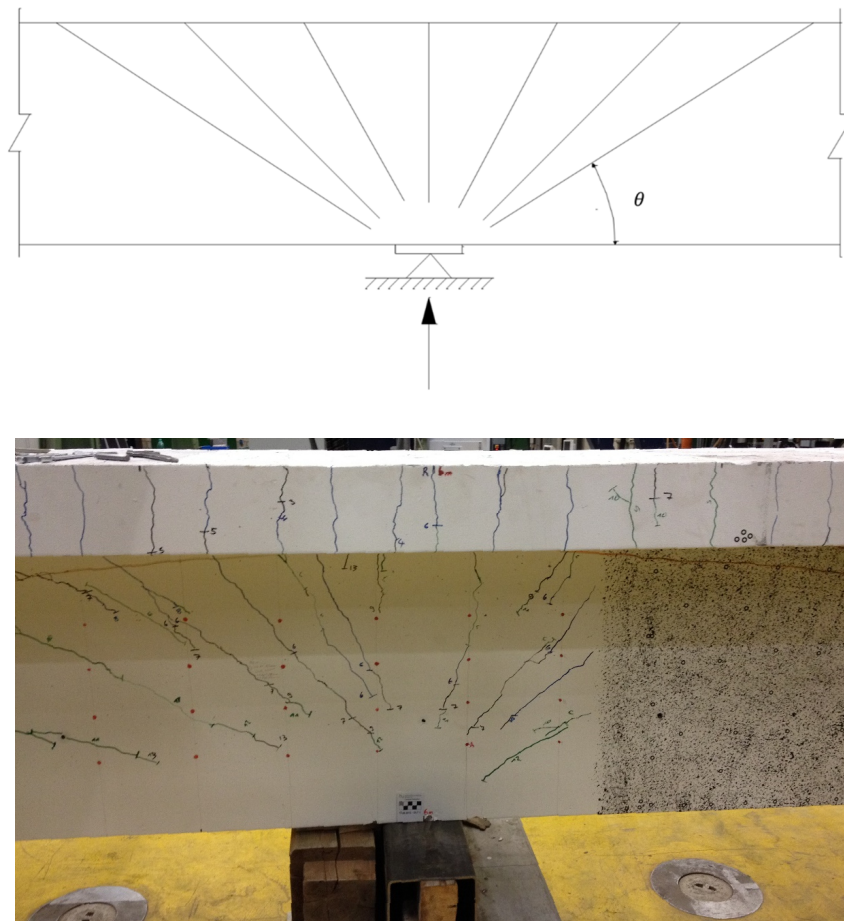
Rissbildung bei Ausbildung eines Fächers (direkte Lagerung): oben – schematische Darstellung, unten – Rissbild eines Versuchsträgers unter Einzellast aus [44]
